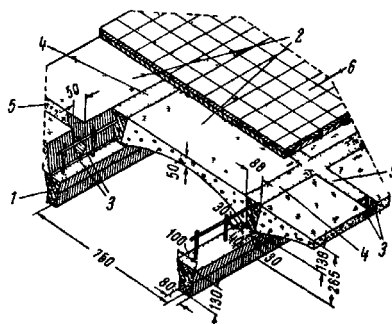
Сборное железобетонное перекрытие составного сечения с облегченными заклиниваемыми элементами (с часторебристым потолком).
